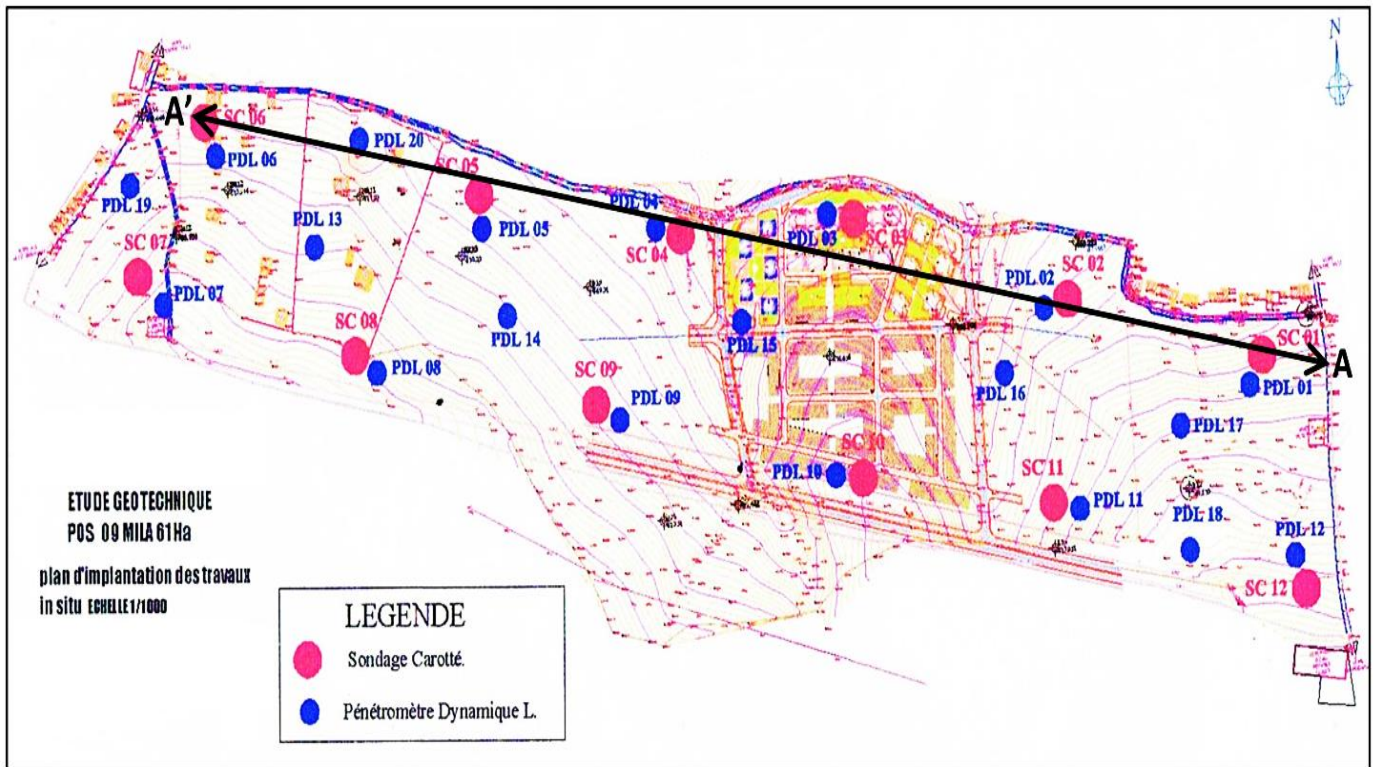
Plan d'implantation des essais in situ (LBM-Sol, 2014).
